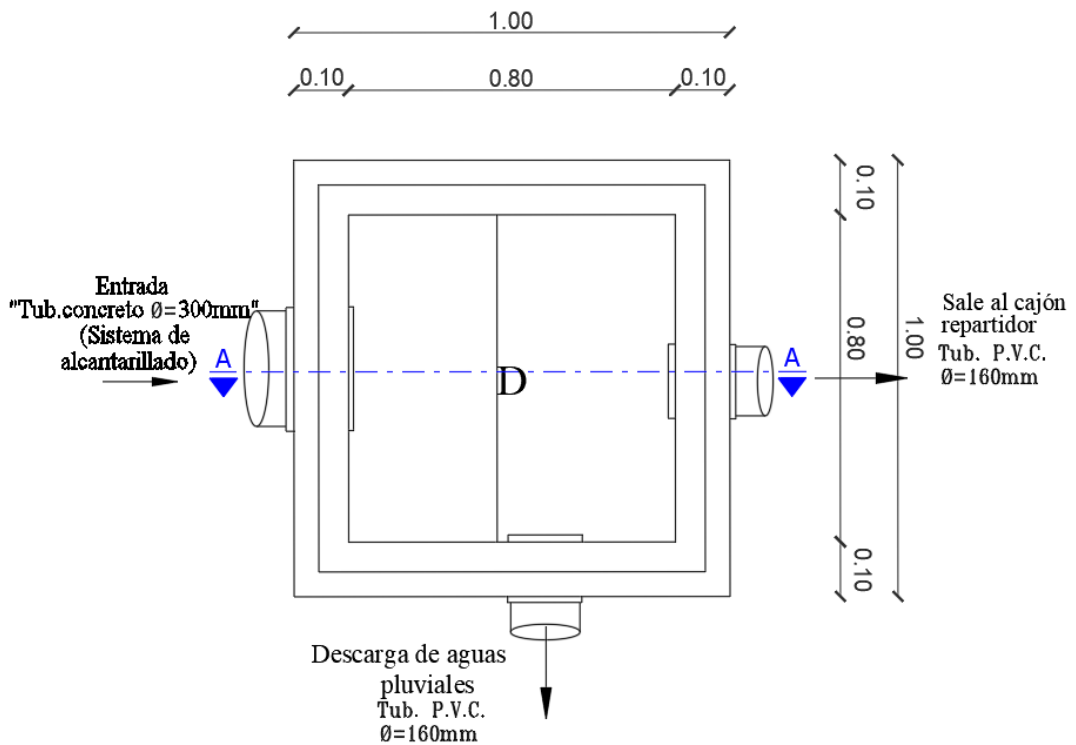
Vista en planta de la caja de alivio con rejilla de cribado
